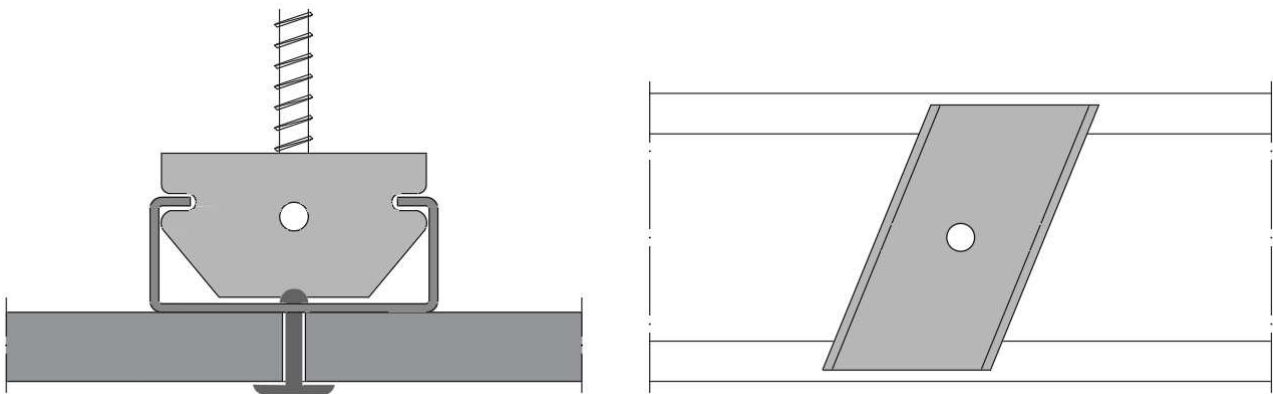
Détail de la fixation du panneau sur le profilé support
